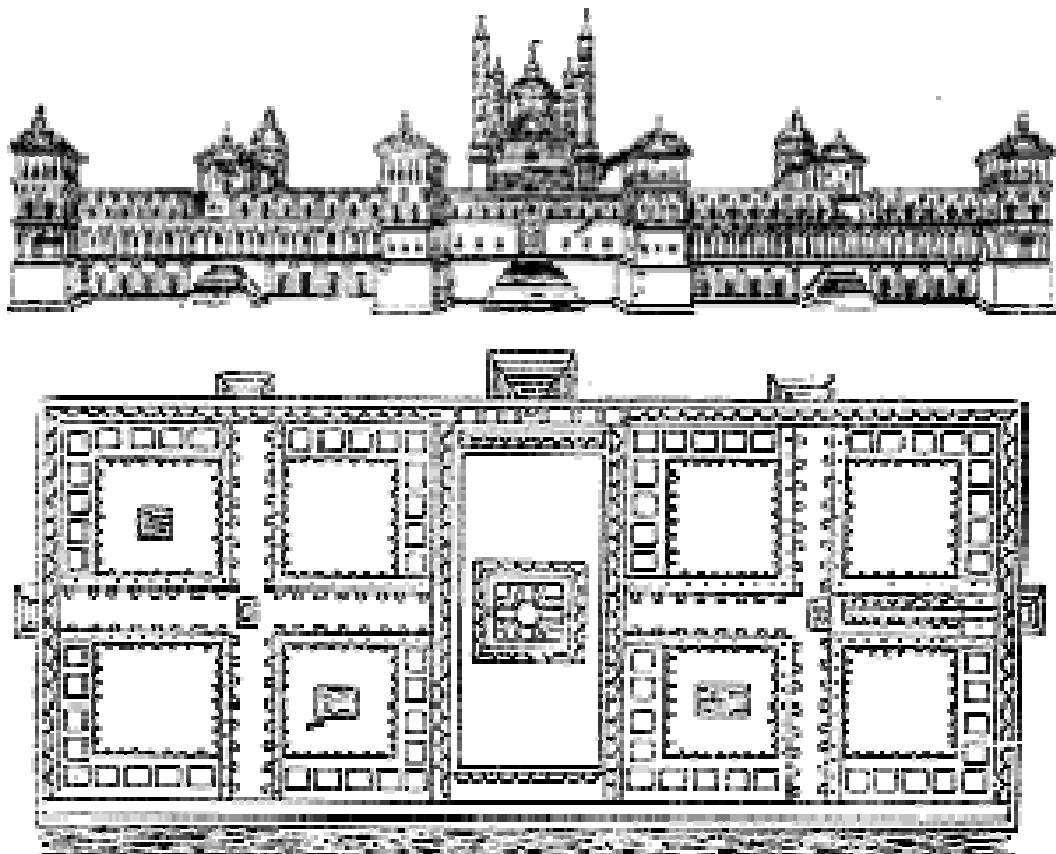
Fachada Simétrica e Planta Baixa do Ospedale Maggiore, em Milão.
